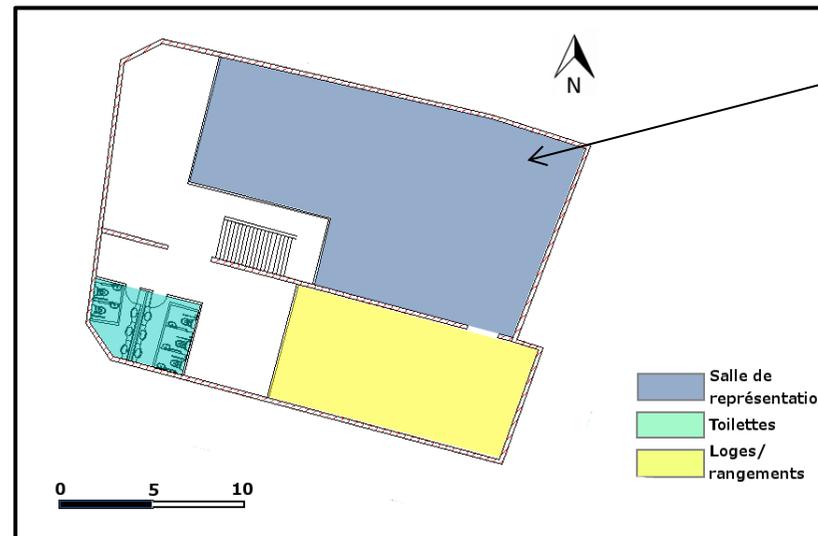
PLAN DE MASSE DU REZ-DE-CHAUSSE DE LA MAISON DE LA JEUNESSE
